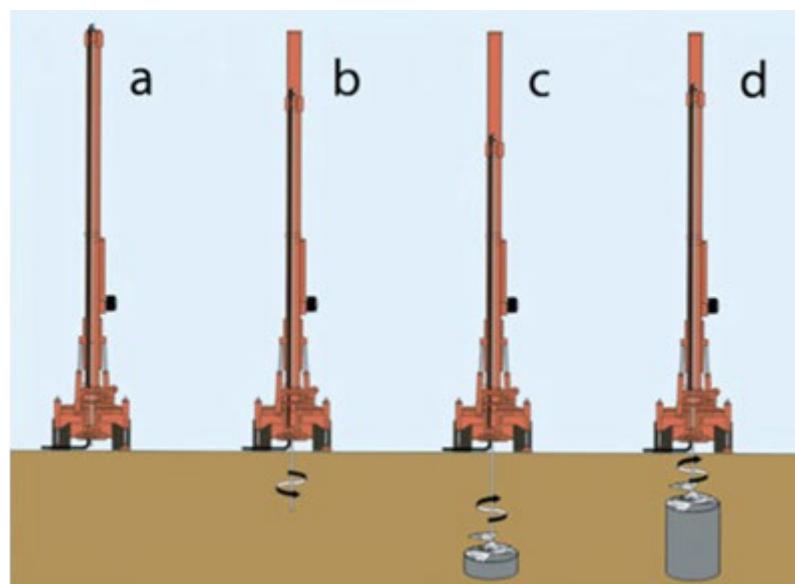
Создание грунтоцементной сваи: a) закачка бетона; b) бурение до проектной отметки; c) подача бетона под давлением; d) формирование тела сваи
